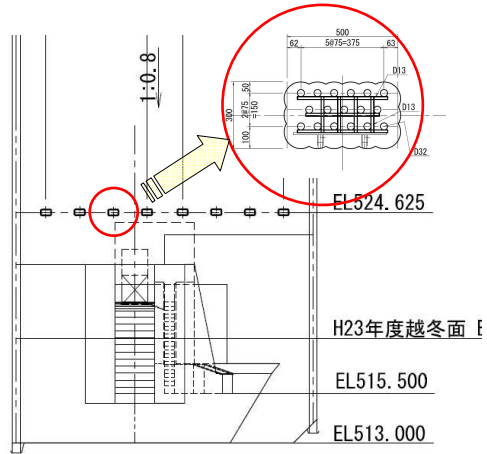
対策② 上下流補強鉄筋工 配筋概要図
